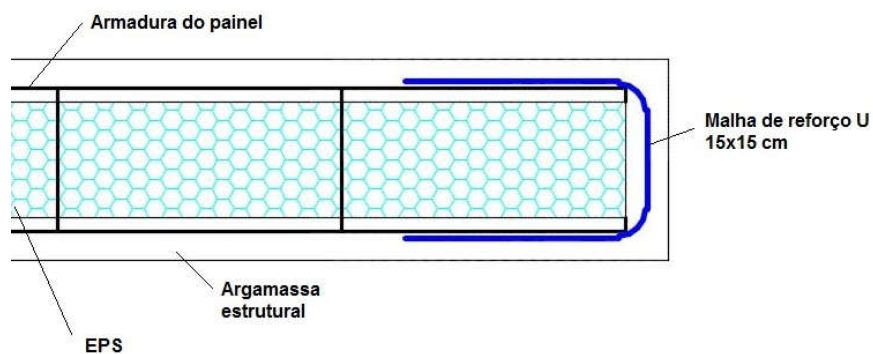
Ancoragem do painel em vigas do pavimento superior
